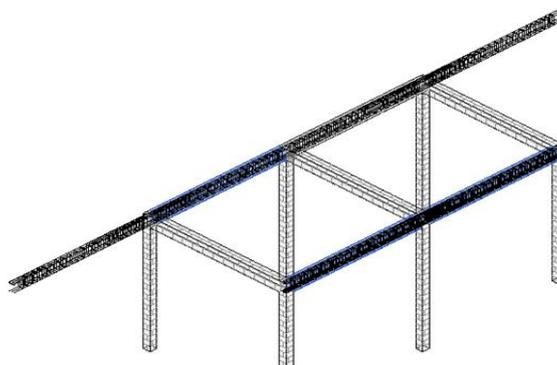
Exemplo de duplicação de informação na passagem de armaduras para Revit.
